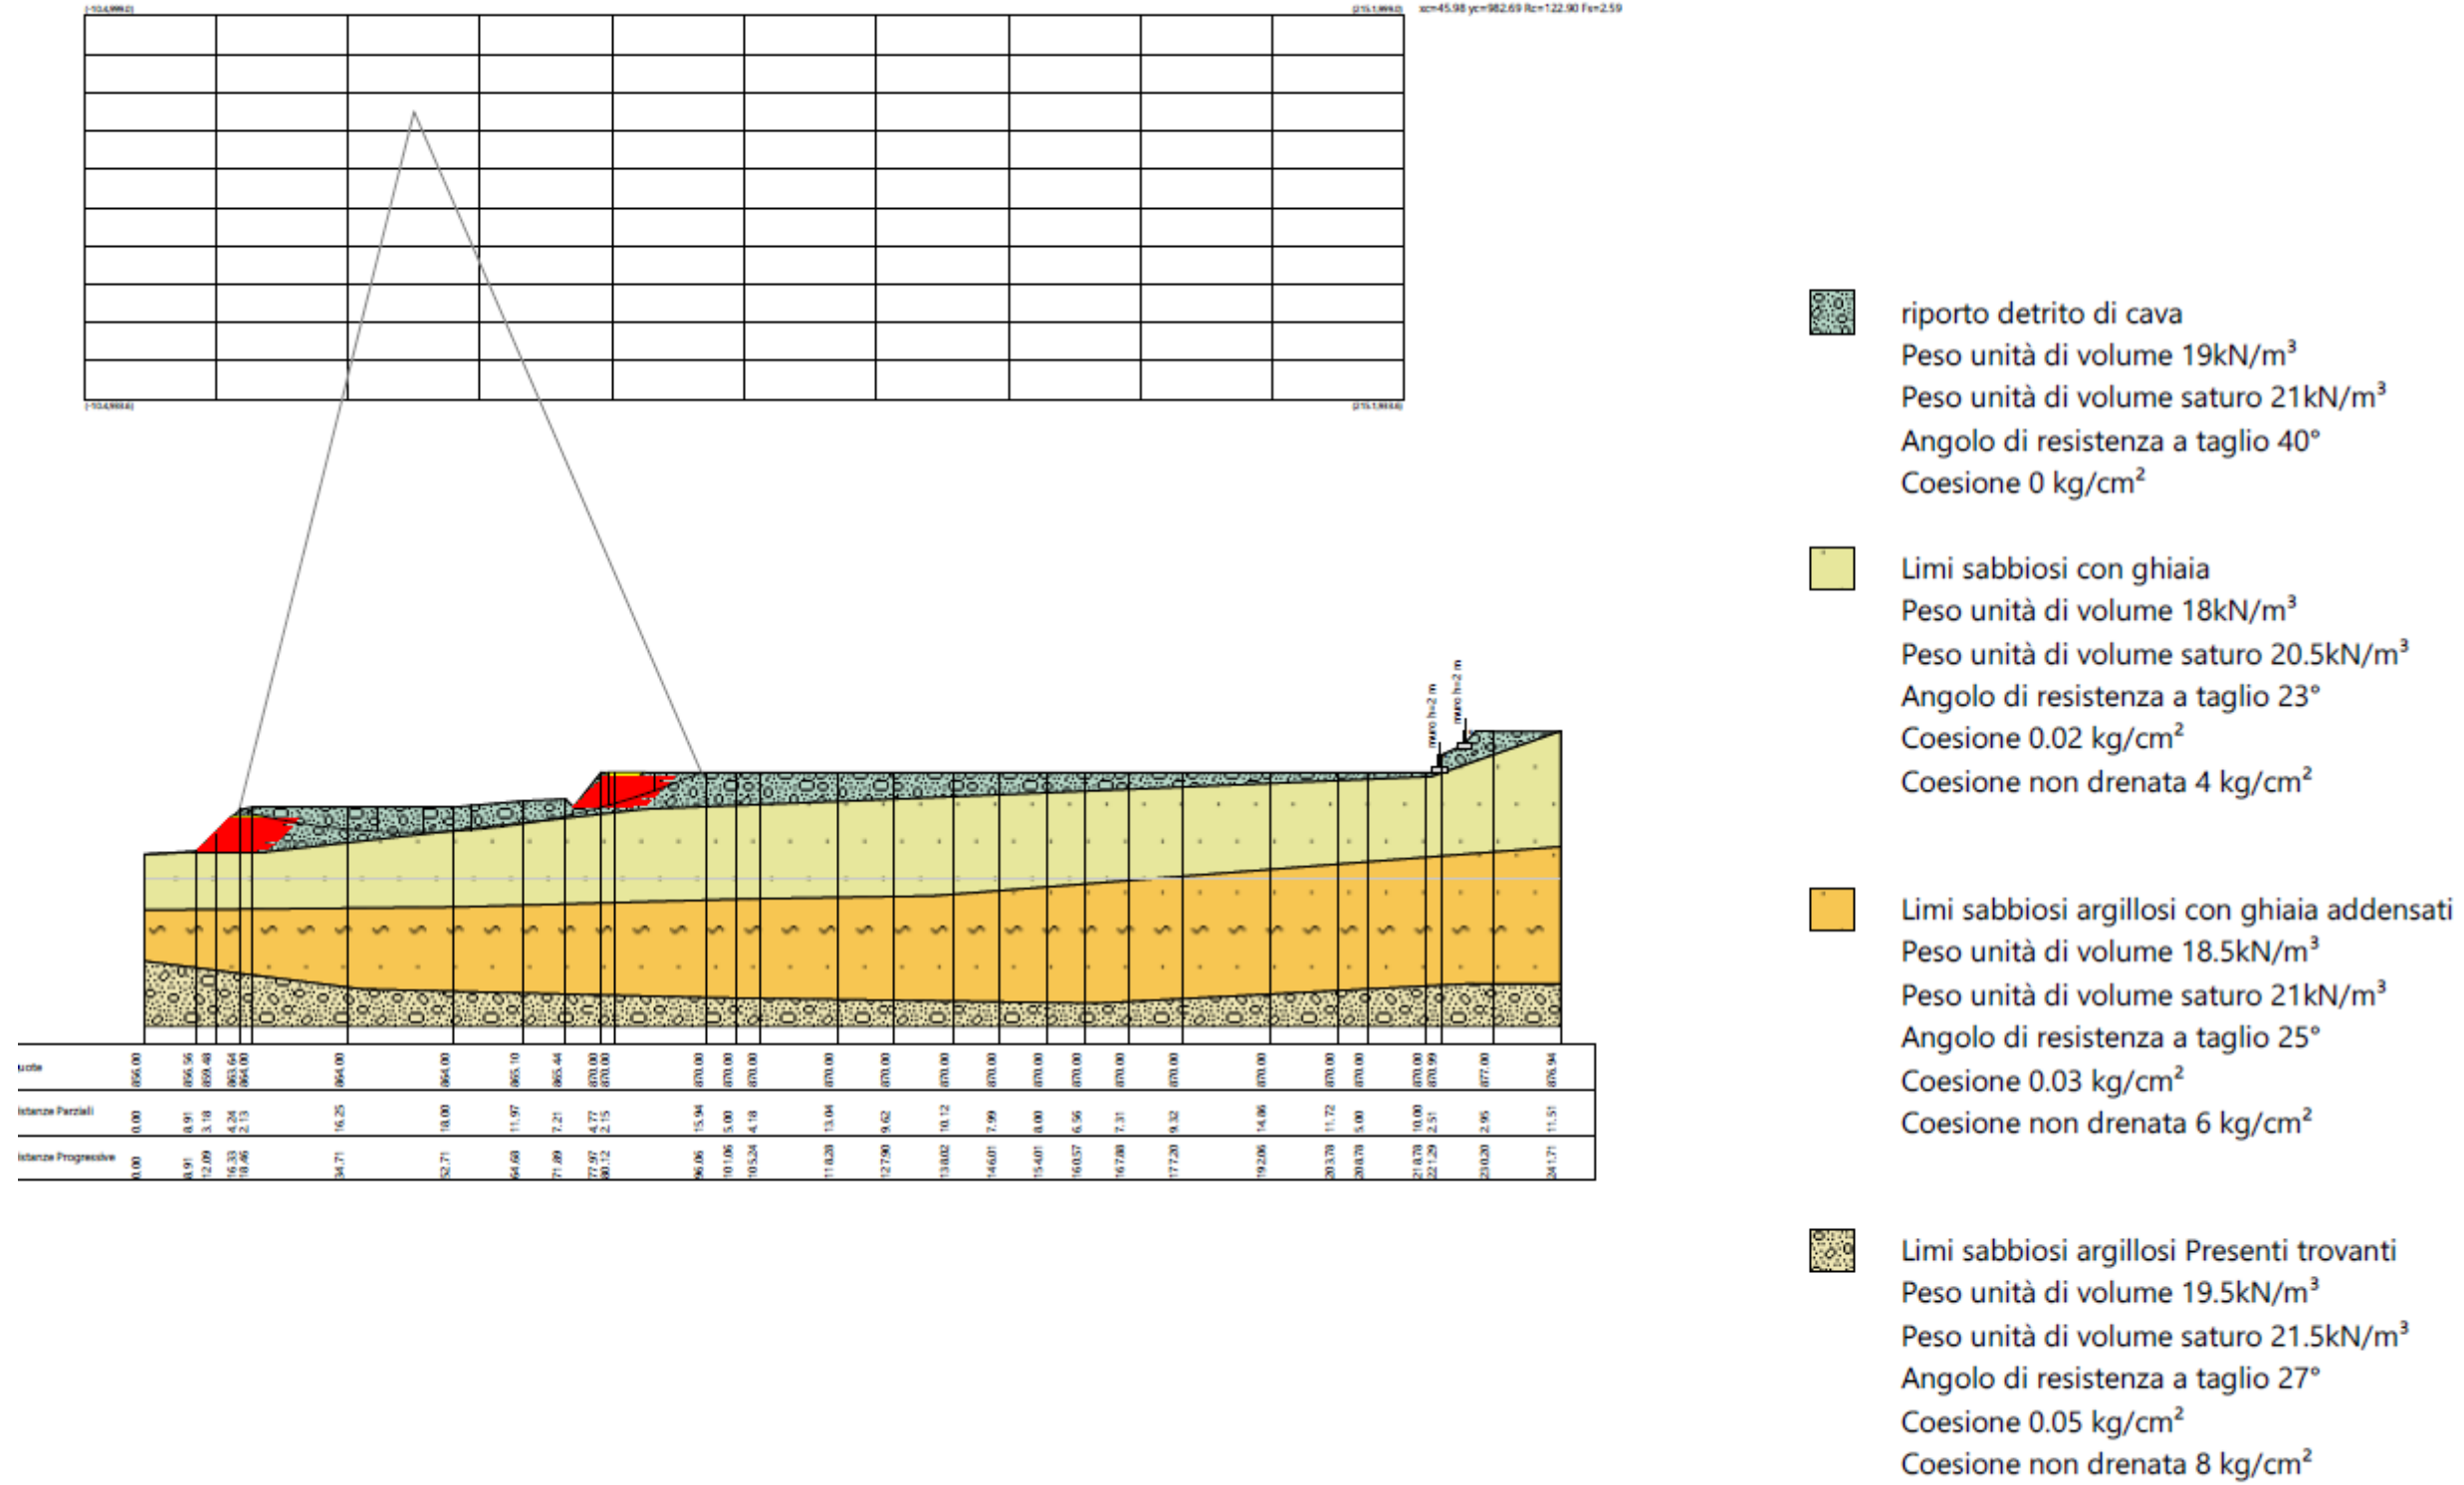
SEZIONE VERIFICA STABILITÀ – STATO DI PROGETTO
